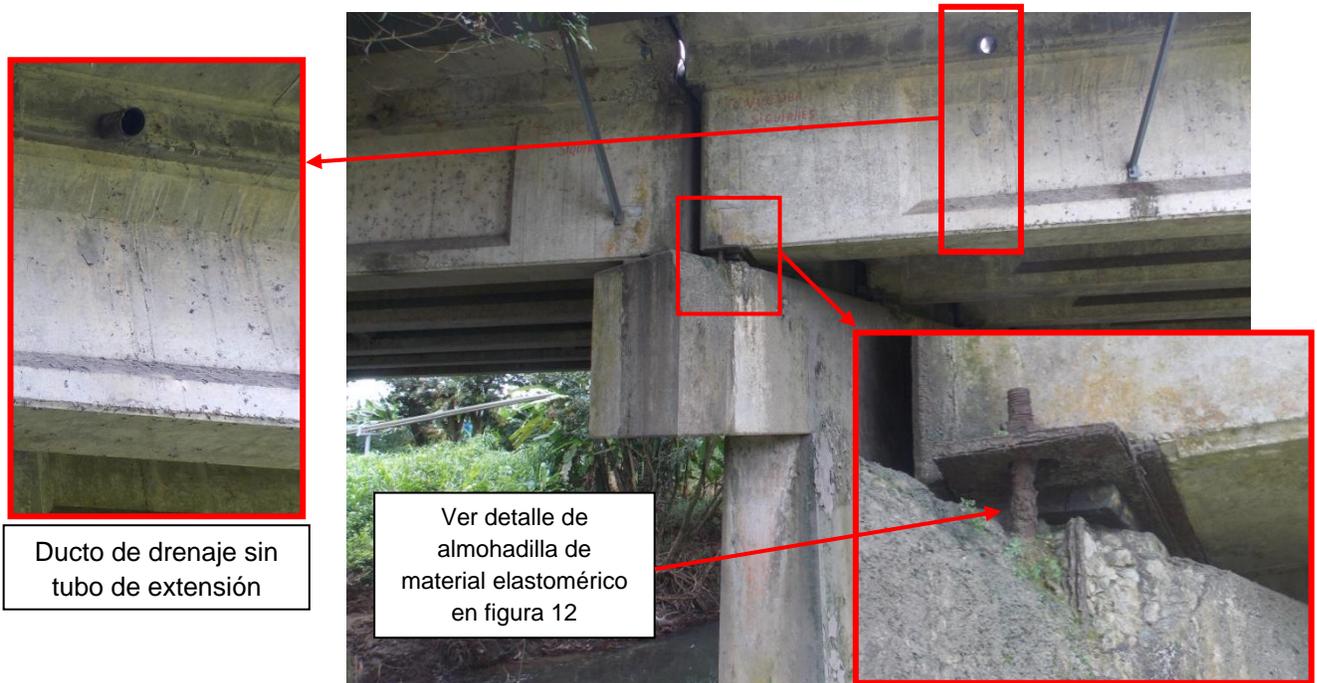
Desprendimientos de concreto en pila 1 que han reducido la longitud de asiento y ductos de drenaje sin tubos de extensión que eviten la descarga directa de agua sobre las vigas.
